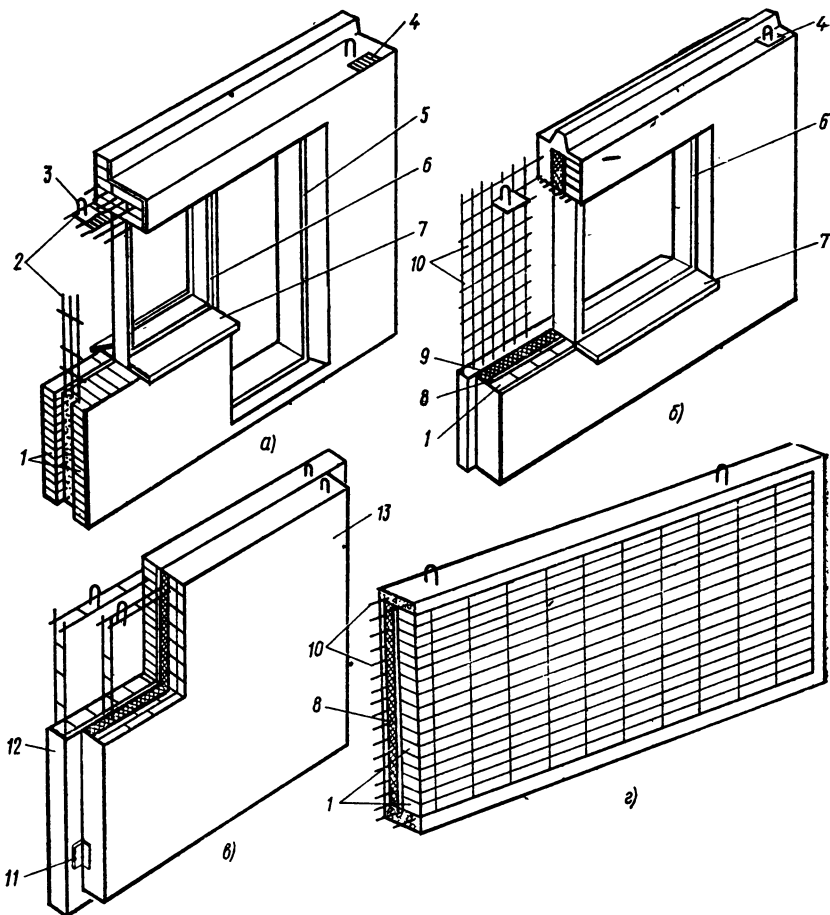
Виброкирпичные панели наружных стен жилых и промышленных зданий:
